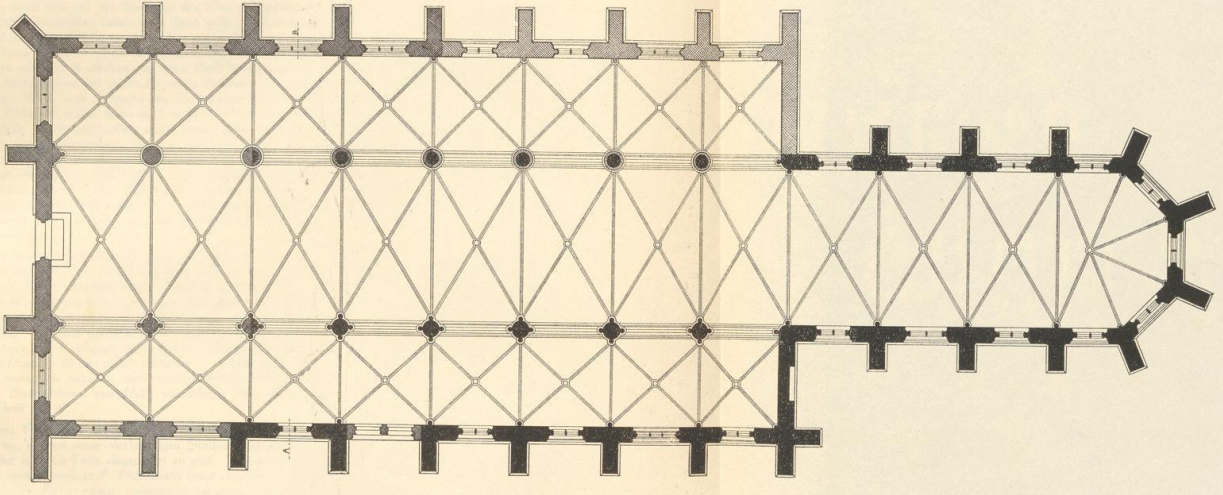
Der Grundriß der Minoritenkirche. Maßstab 1:200
